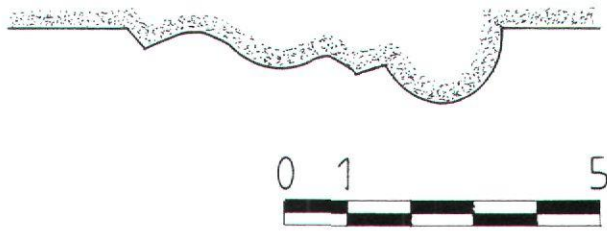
Detail opbouw plafond met aansluiting op wand (tekening E. Orsel)
